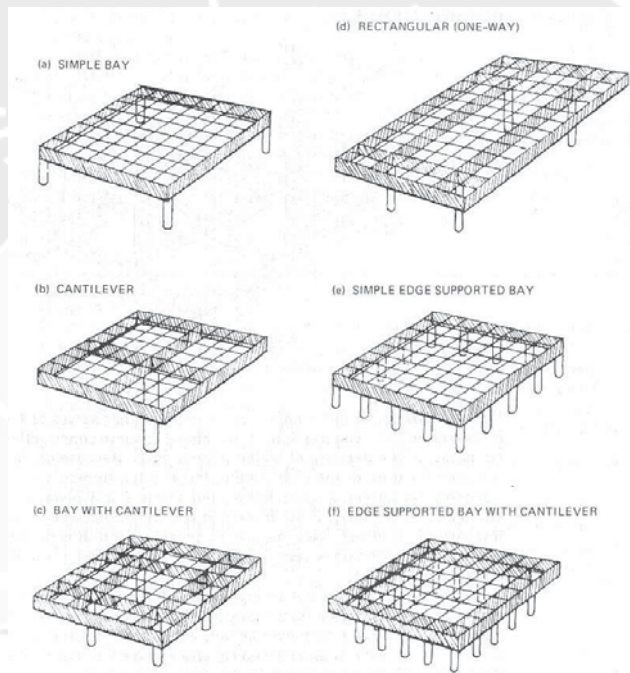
Sub-Struktur Horizontal – Joists & Girder
